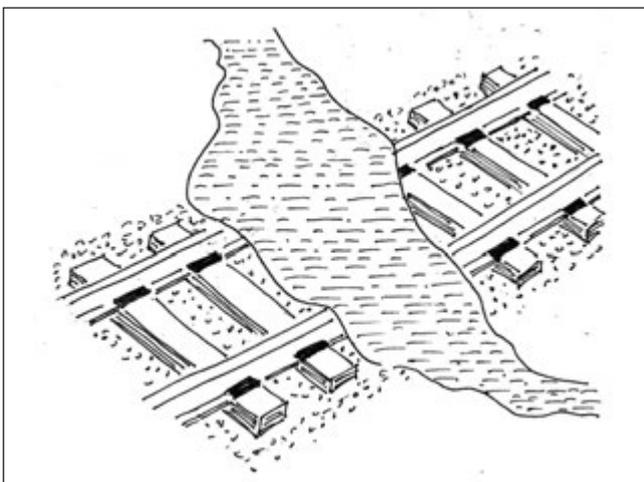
Esondazione ed allagamento della sede ferroviaria.
